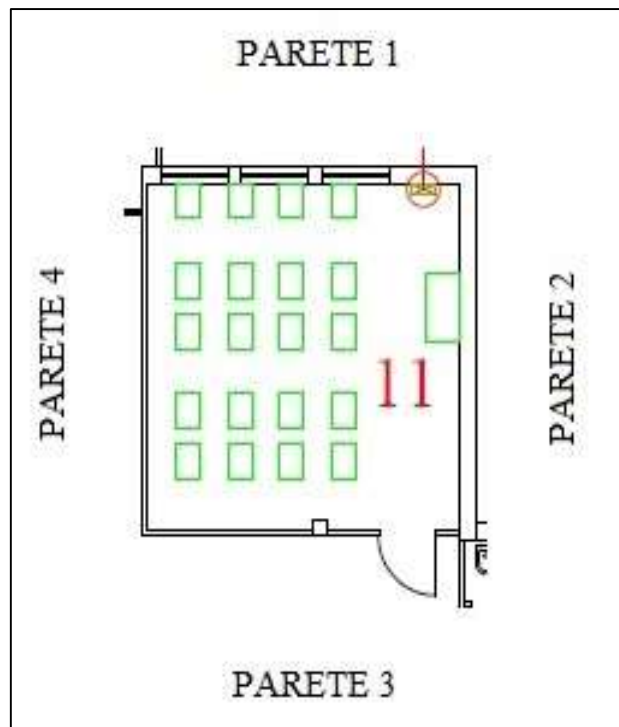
Planimetria dell’Aula 11 (1°A) oggetto di misurazioni
